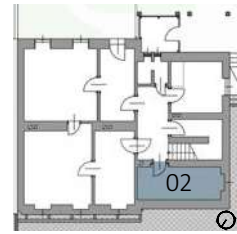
Grundriss UG 02 Keller, M=1:100.
